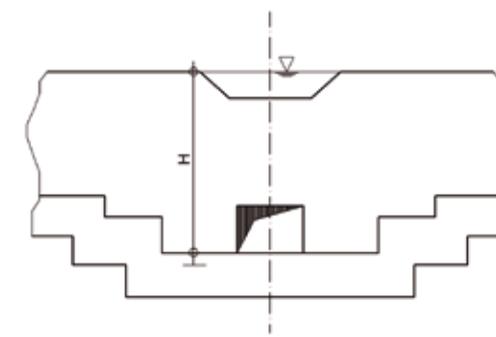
Skizze Regelfall Betonstauerbauwerk
